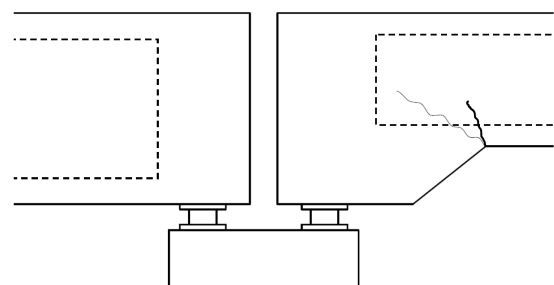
支点付近ウェブの斜めひび割れ
